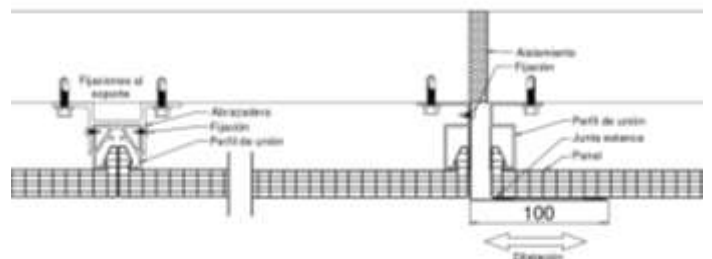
Junta de dilatación entre paneles del sistema como cerramiento de fachada.
